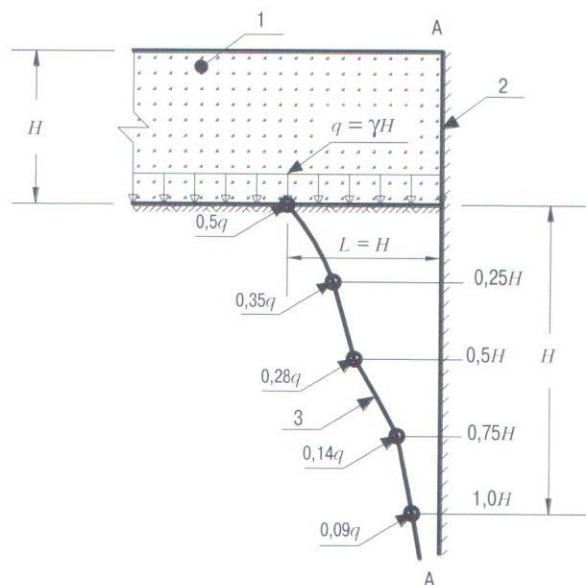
Эпюра горизонтального давления грунта основания на заднюю грань А-А свайного фундамента устоя:
